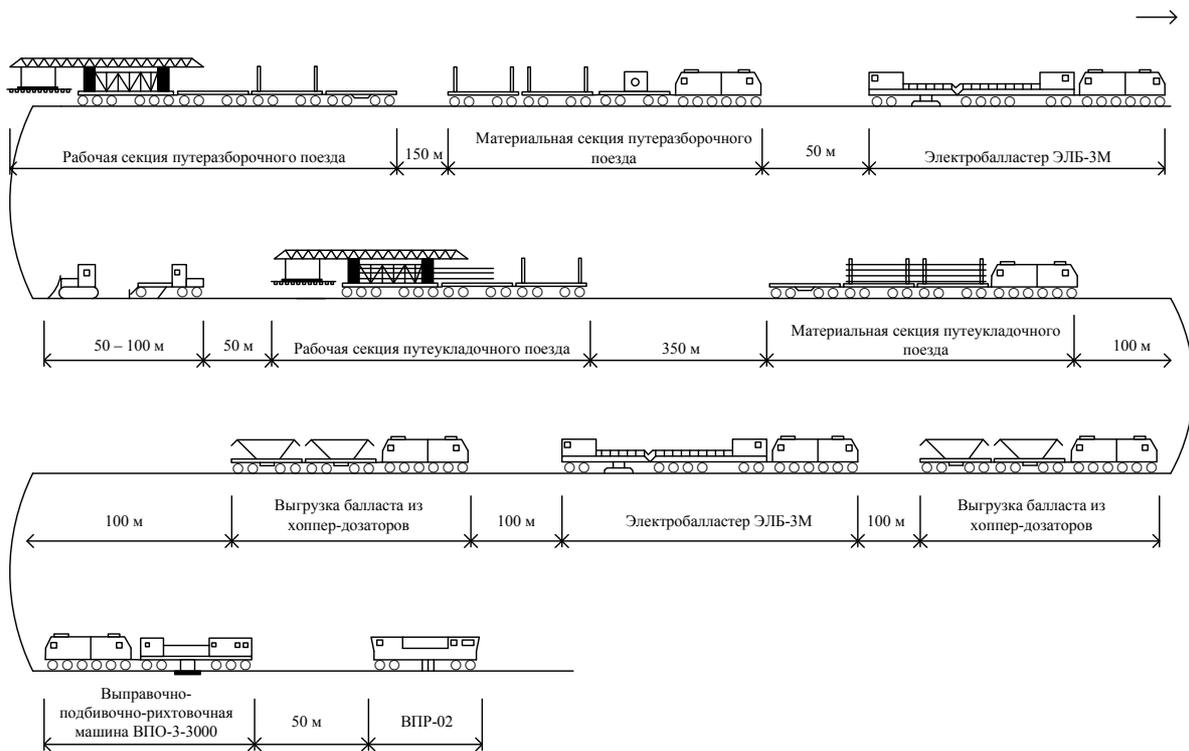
Схема формирования рабочих поездов на перегоне
